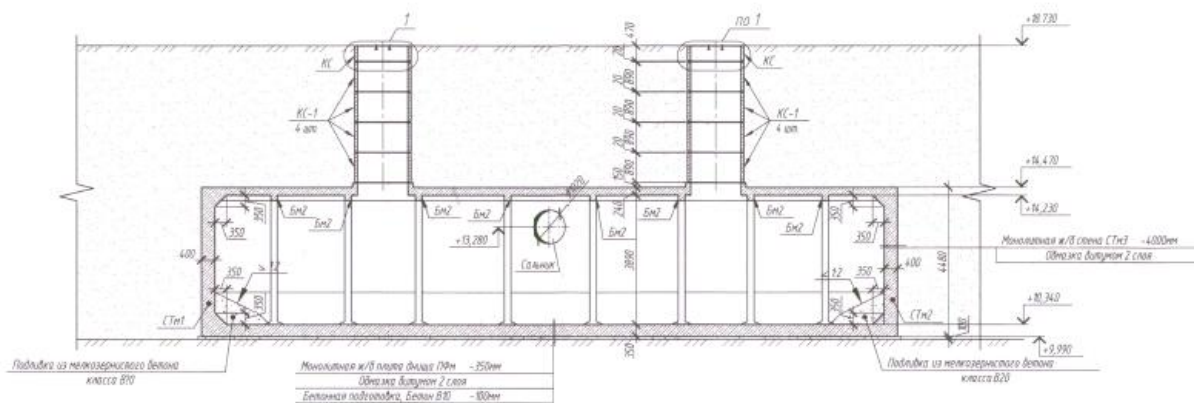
Поперечный конструктивный разрез резервуара ливневых стоков.
